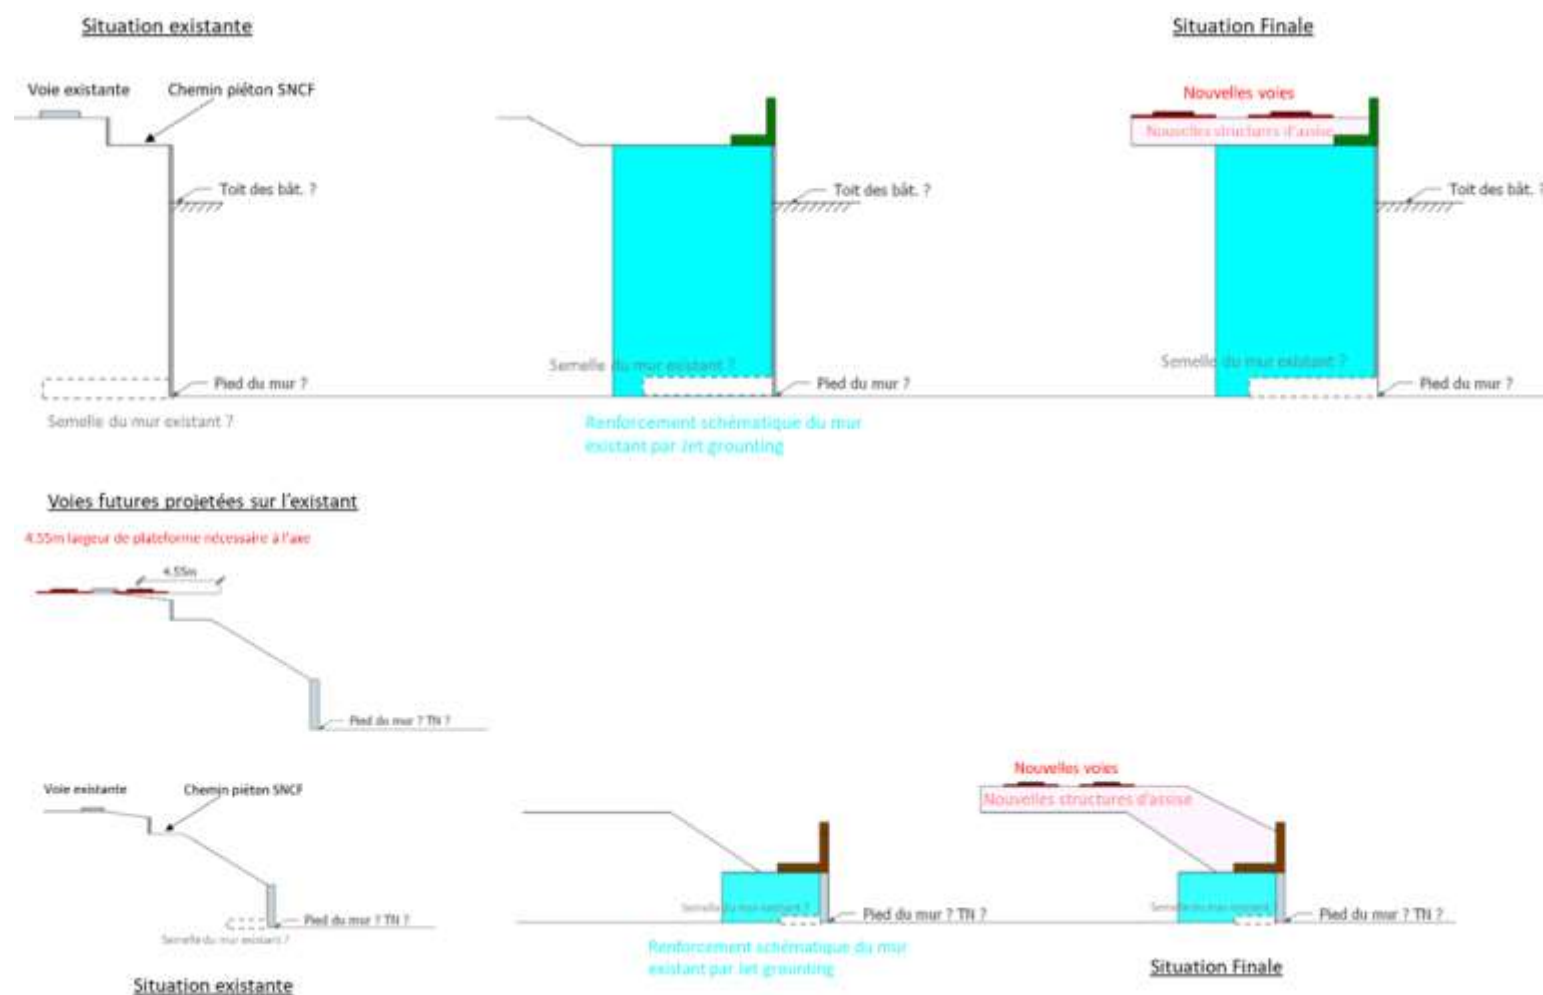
Principes de renforcement du mur existant par Jet Grouting
